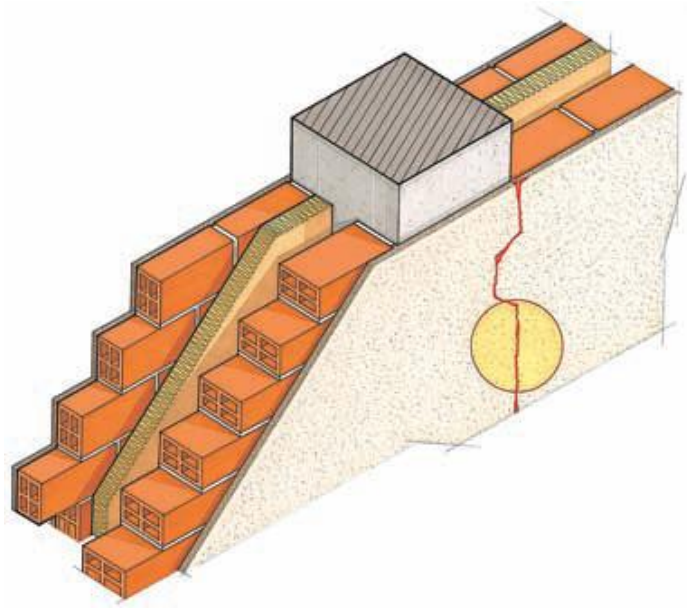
e 19 – Fenomeni di fessurazione verticale del solo strato di intonaco in corrispondenza di un pilastro
